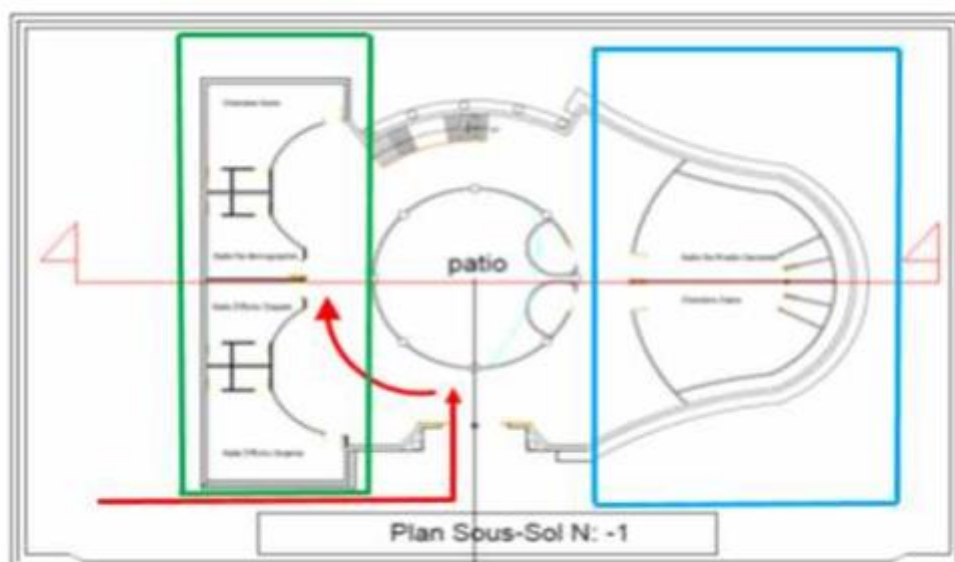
Plan Sous-Sol niveau : -1. Source : auteur
